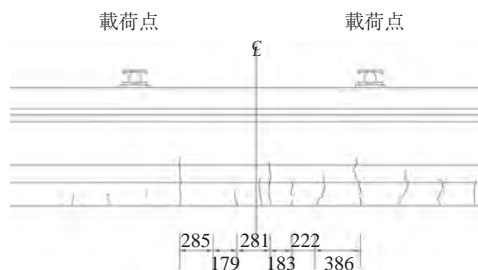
実規模試験体のひび割れとひび割れ間隔
